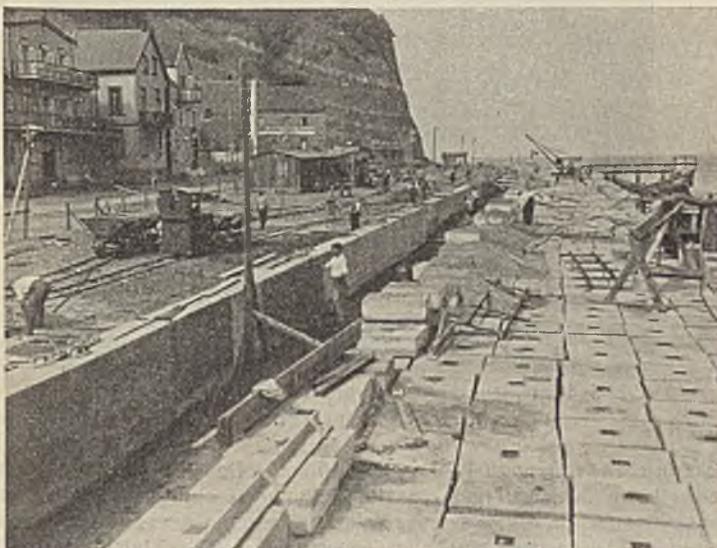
Vorläufig abgesetzte Betonplatten und Abwehrmauer.
